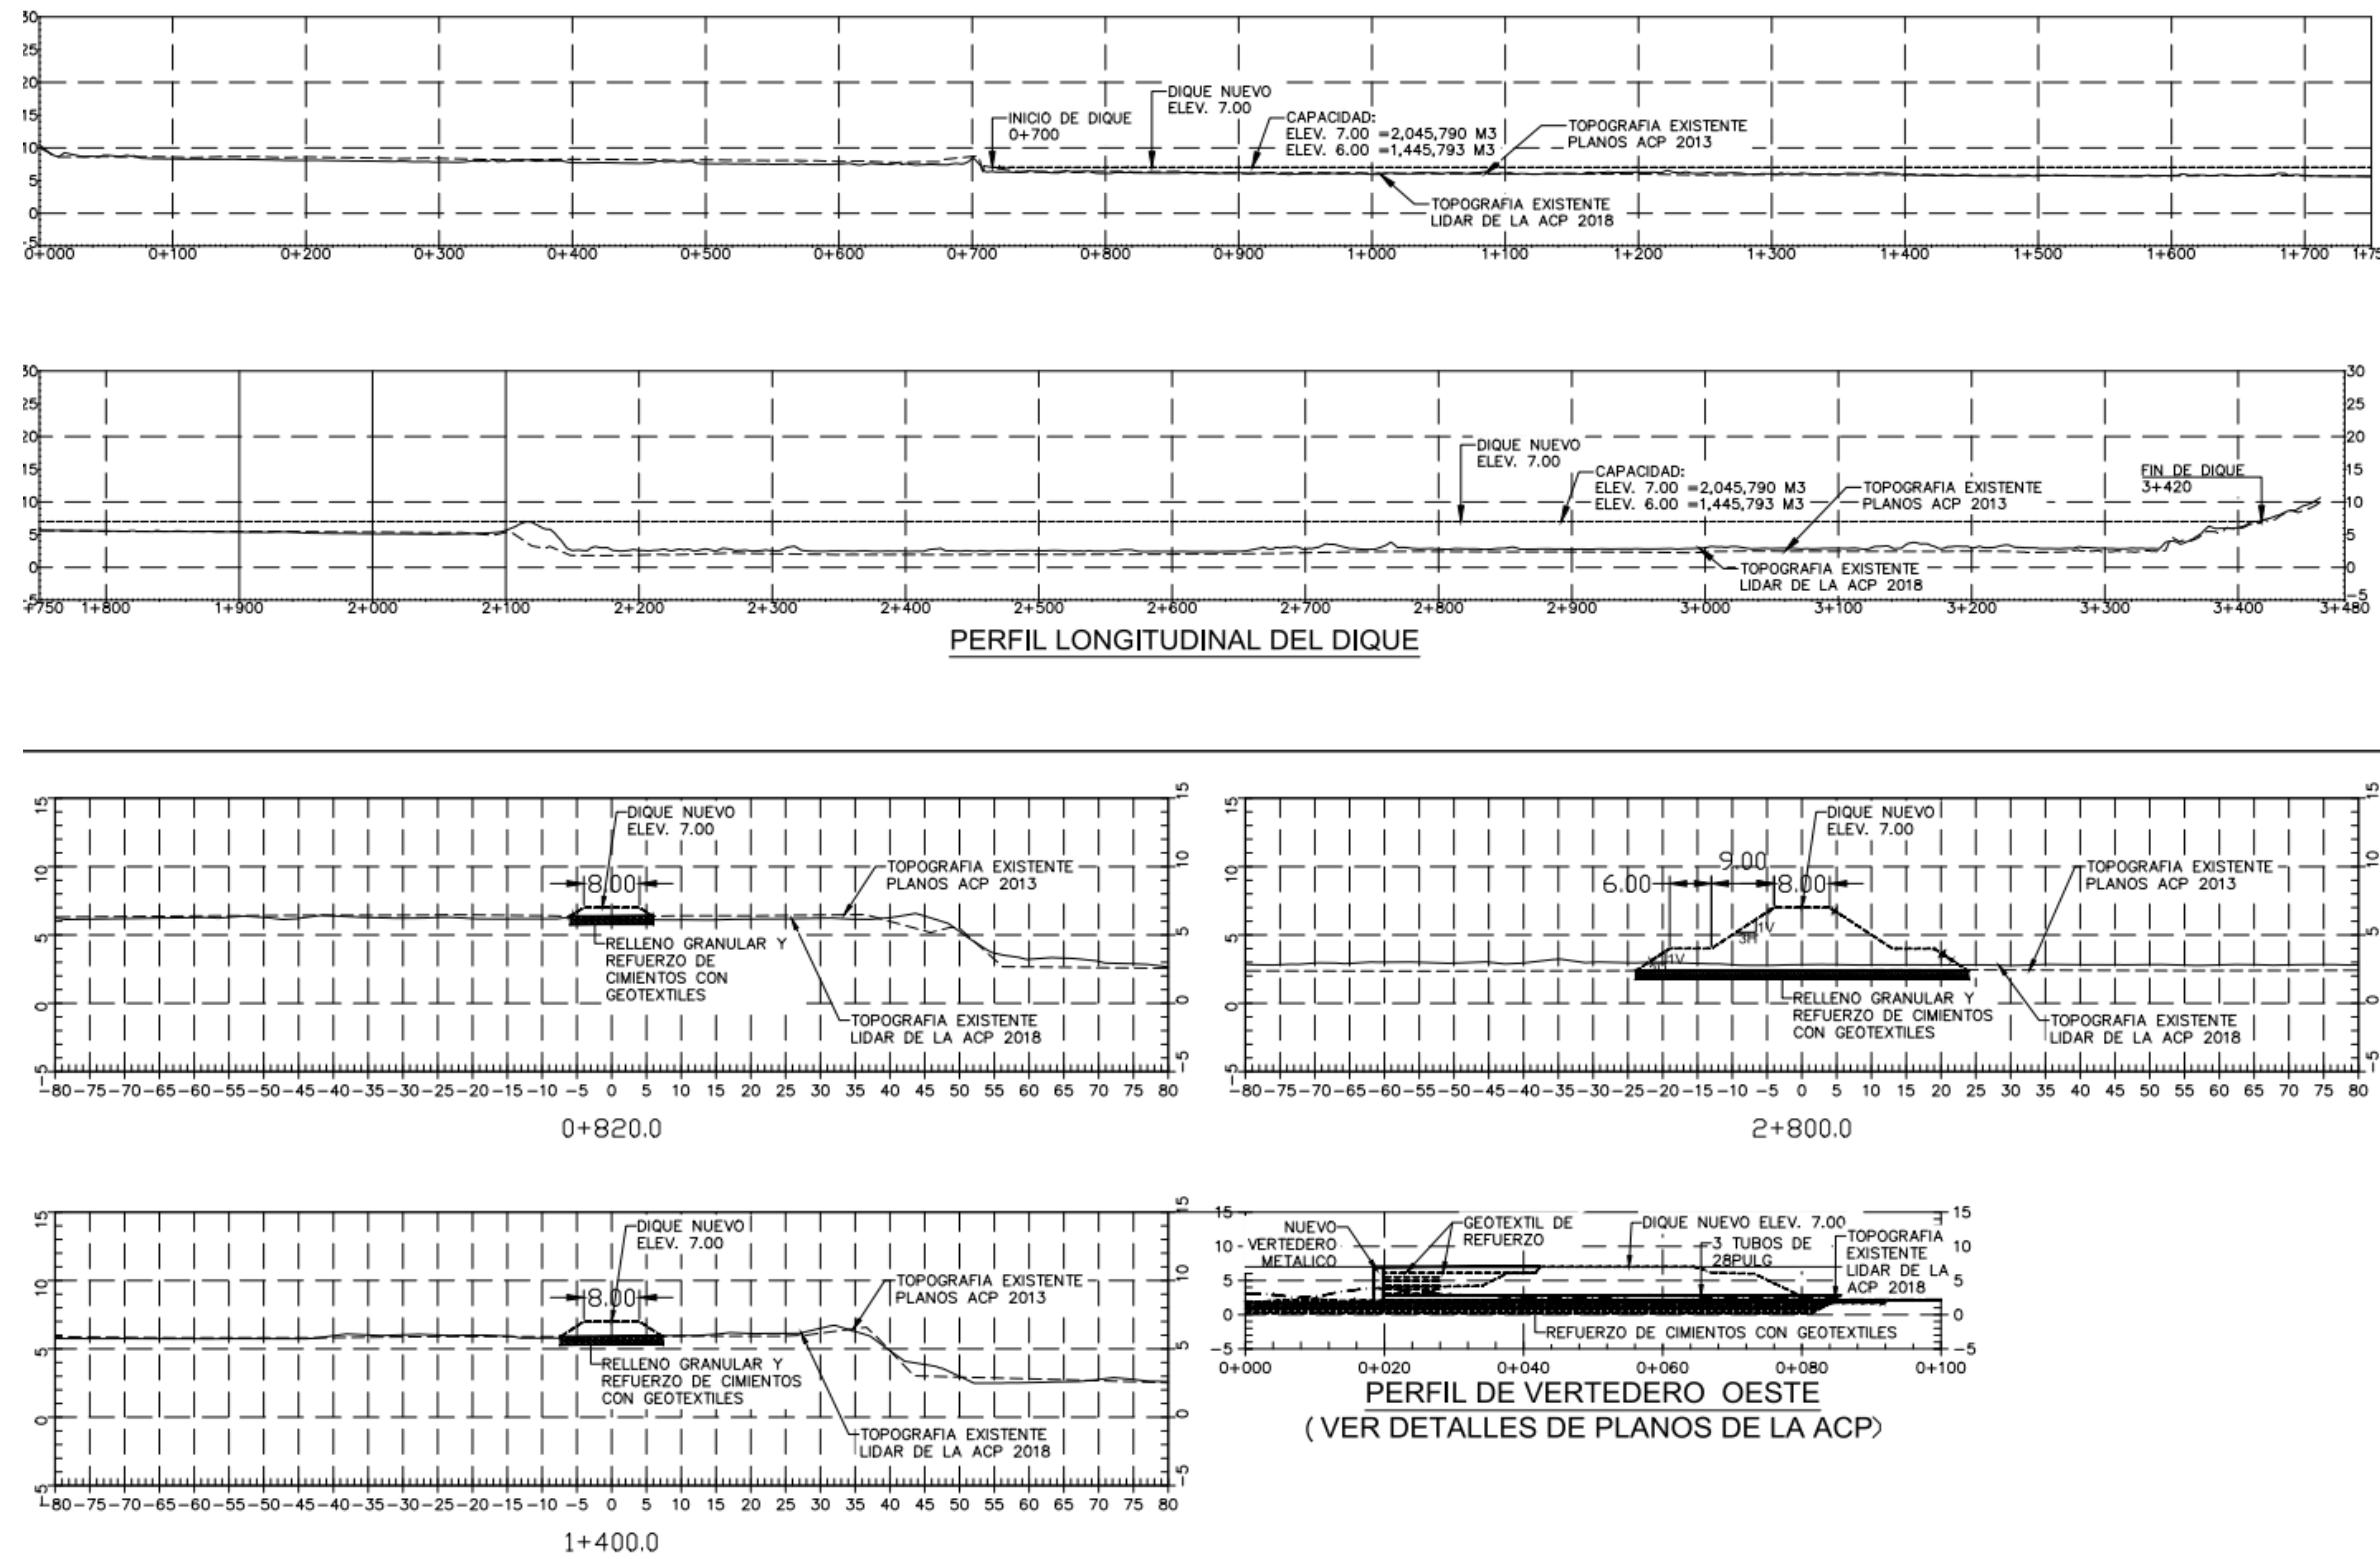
Perfil longitudinal y secciones de la estructura de contención o dique.
